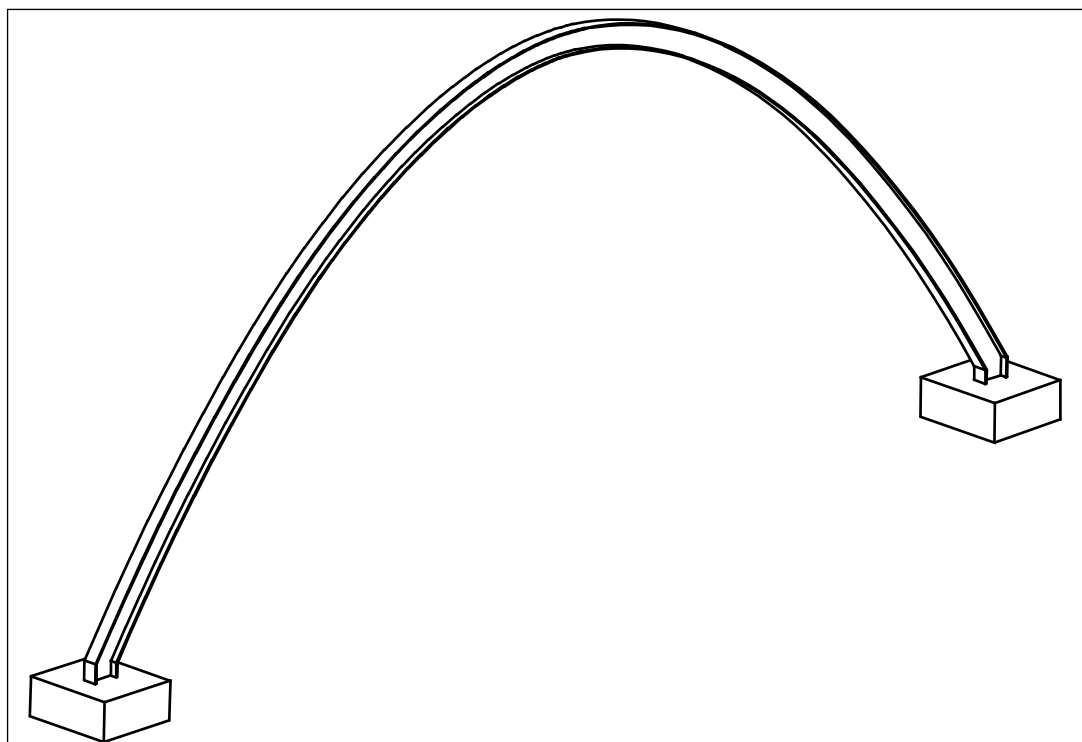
Forma general del pórtico tipo y zapatas de cimentación
